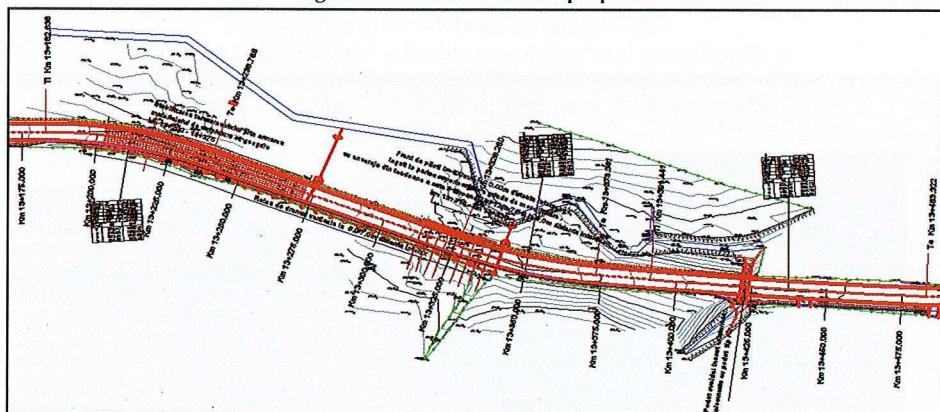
Amplasarea în plan a pozițiilor de consolidare
